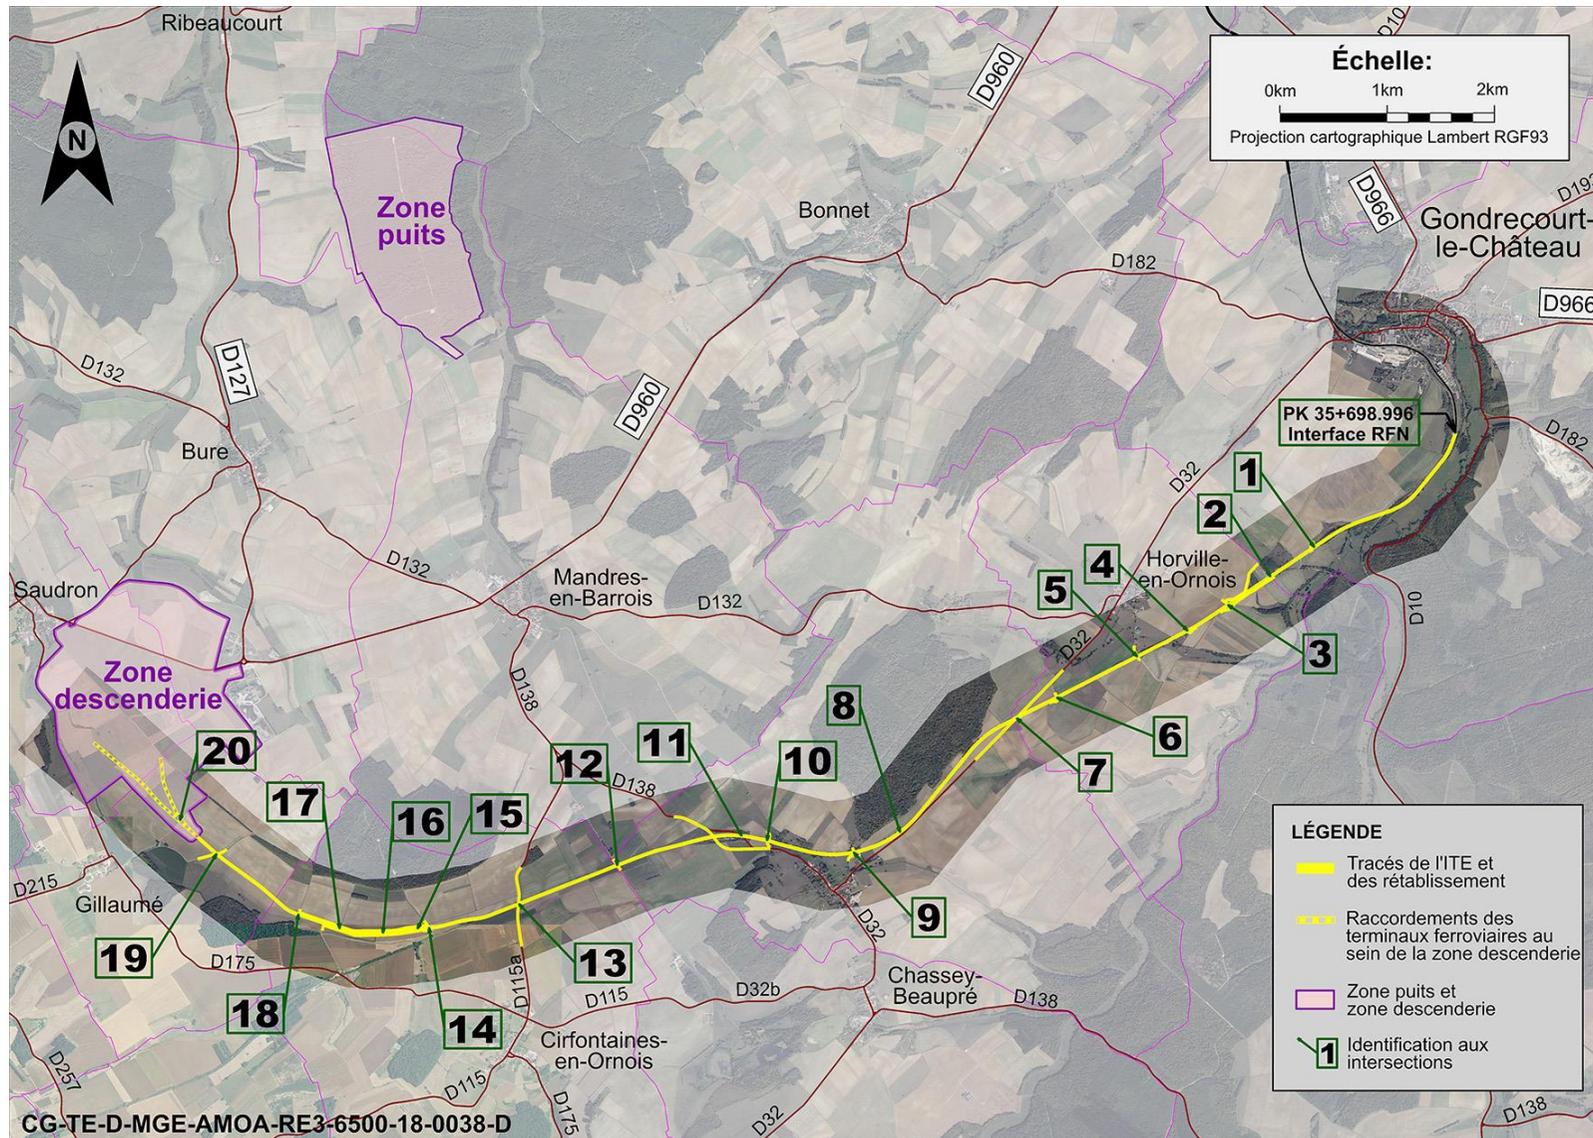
Tracé de l'ITE hors plateforme à Gondrecourt-le-Château
